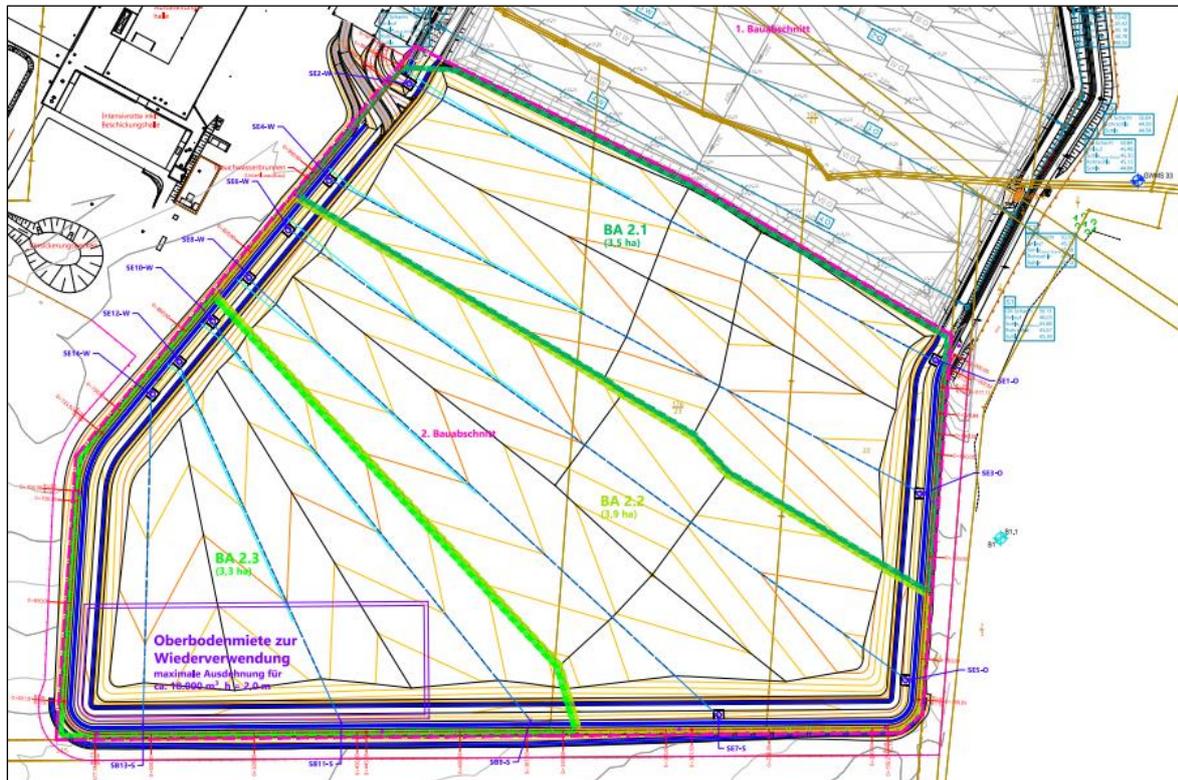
Lageplan Teilbauabschnitte mit Darstellung der geplanten temporären Bodenmiete /10/
